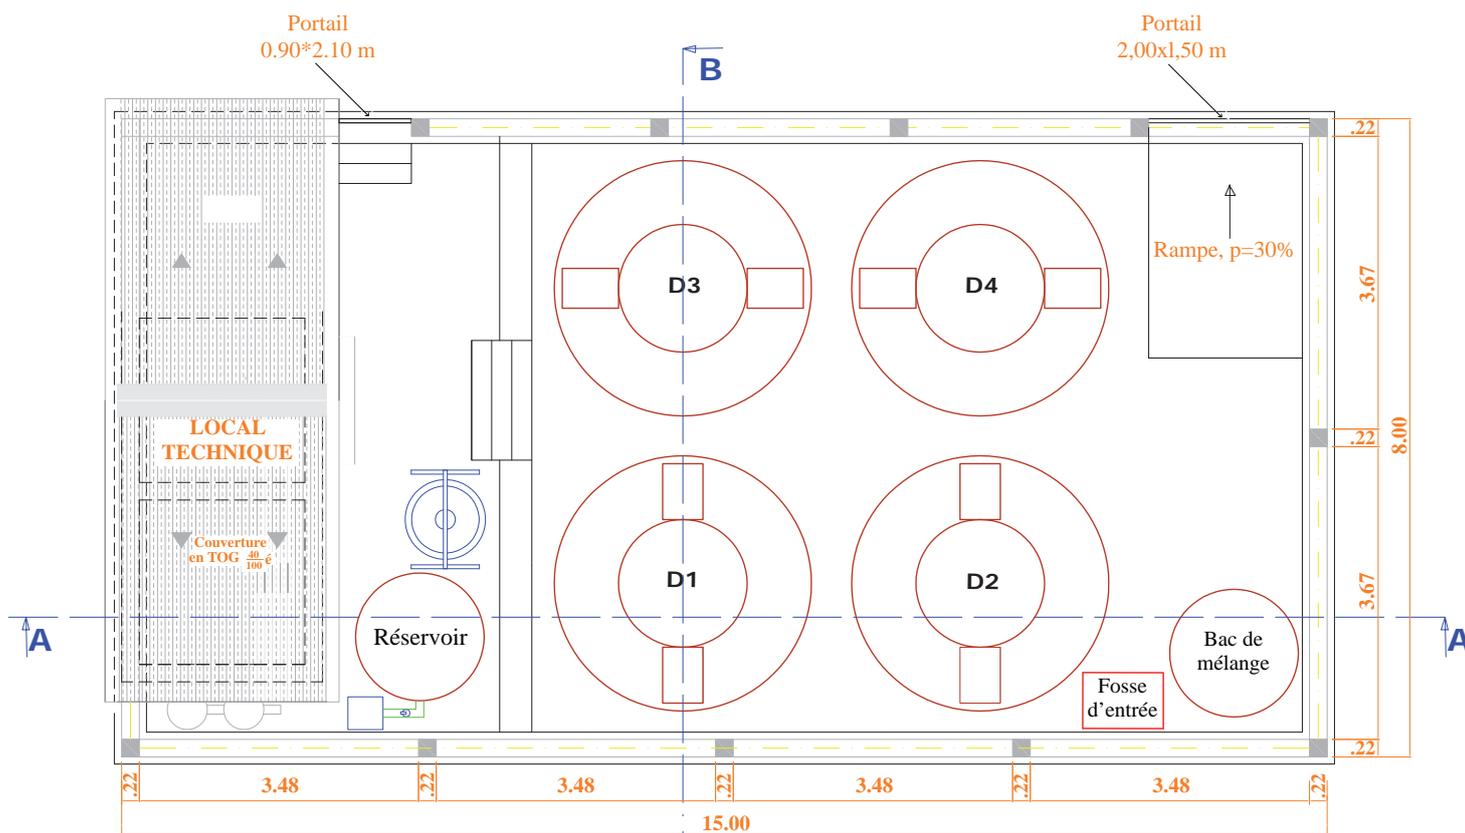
Plan d'implantation de la station de traitement d'Avaratetezana
